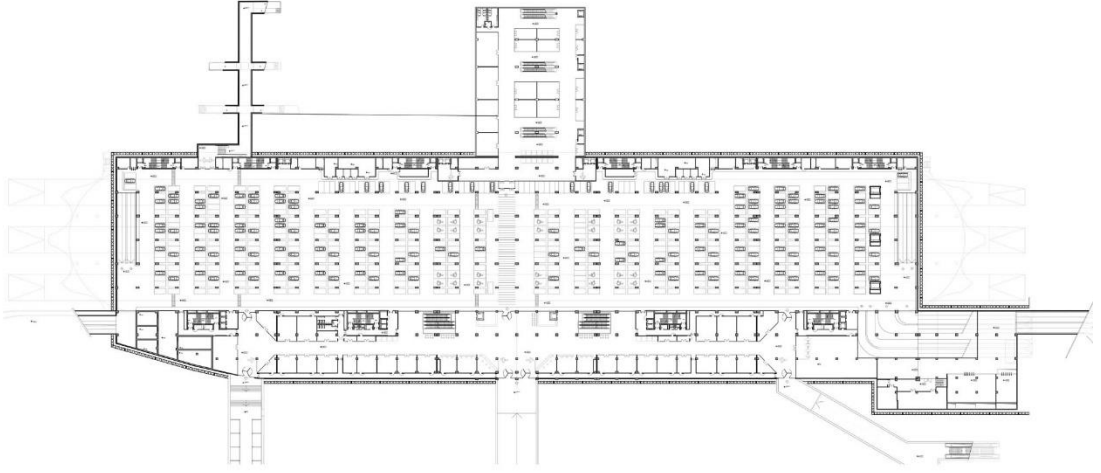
Ankara yüksek hızlı tren garı vaziyet planı (URL-11)
